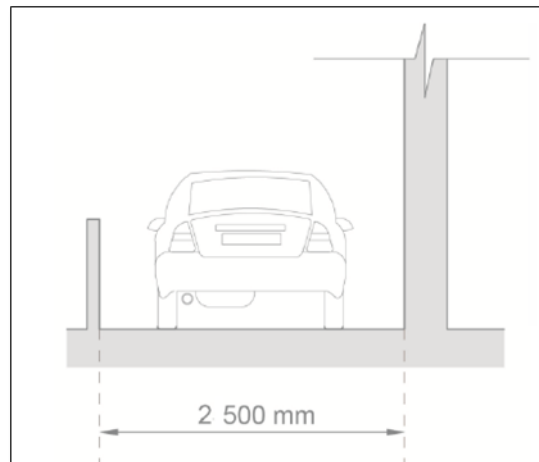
Estacionamiento delimitado con parámetros verticales
